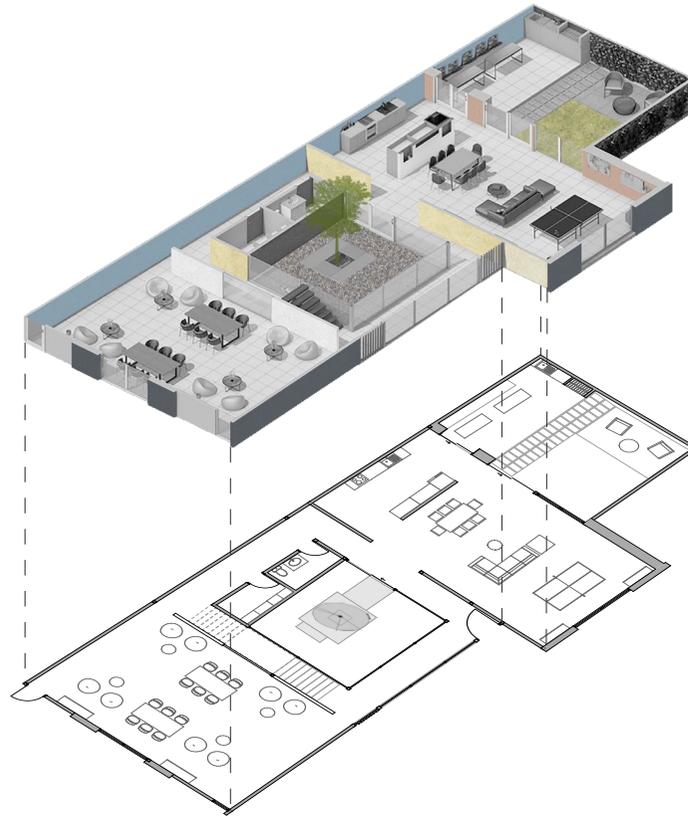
Planta baja, donde se evidencia la propiedad -distribución interna- en base a los resultados del test aplicado
